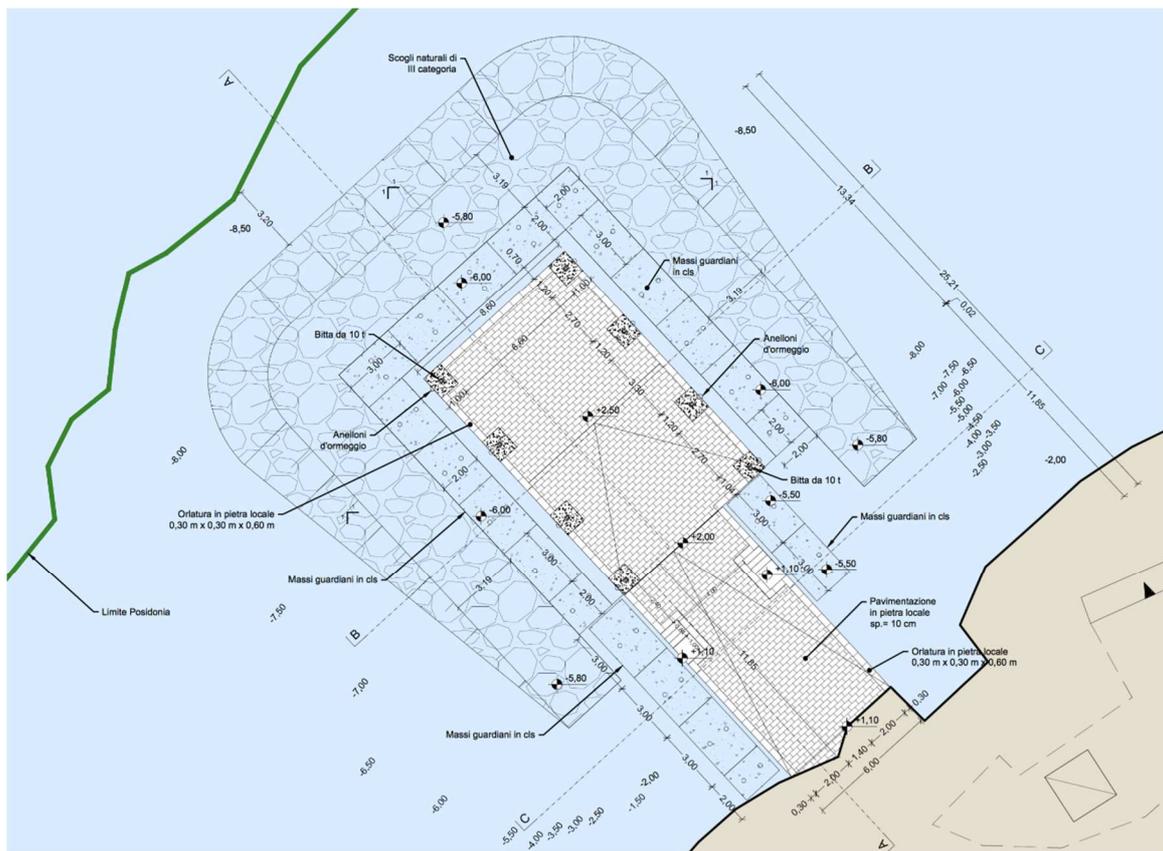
Alternativa 3: Planimetria al finito estratta da 2017E037INV-02-D-OM-TAV0001
